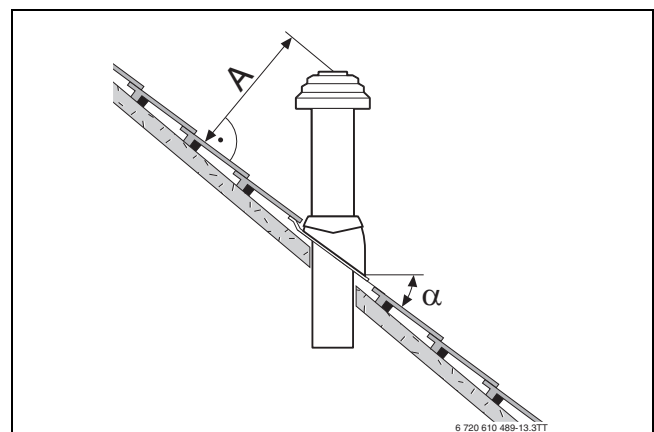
Abstandsmaße und Dachneigungen bei Schrägdach
